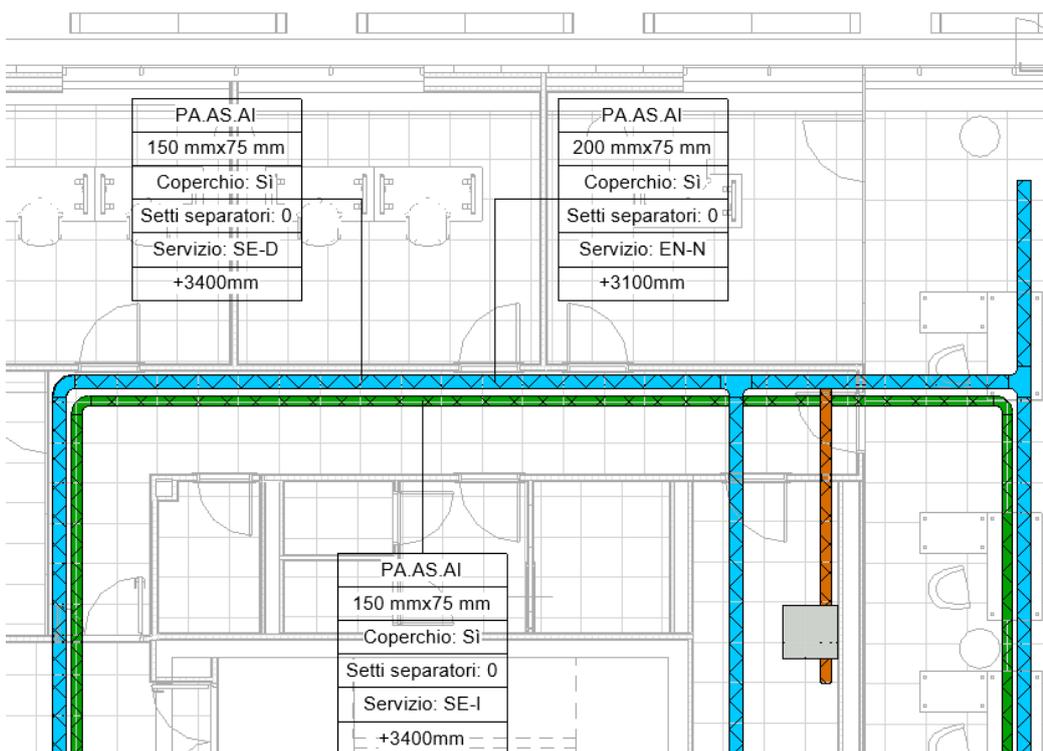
Vista in pianta della distribuzione a soffitto con etichette con quota
